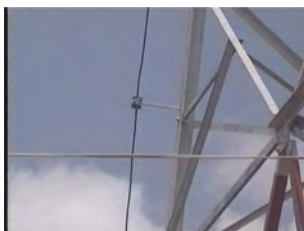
Vista del cable de bajada del pararrayos aislado de la estructura.
